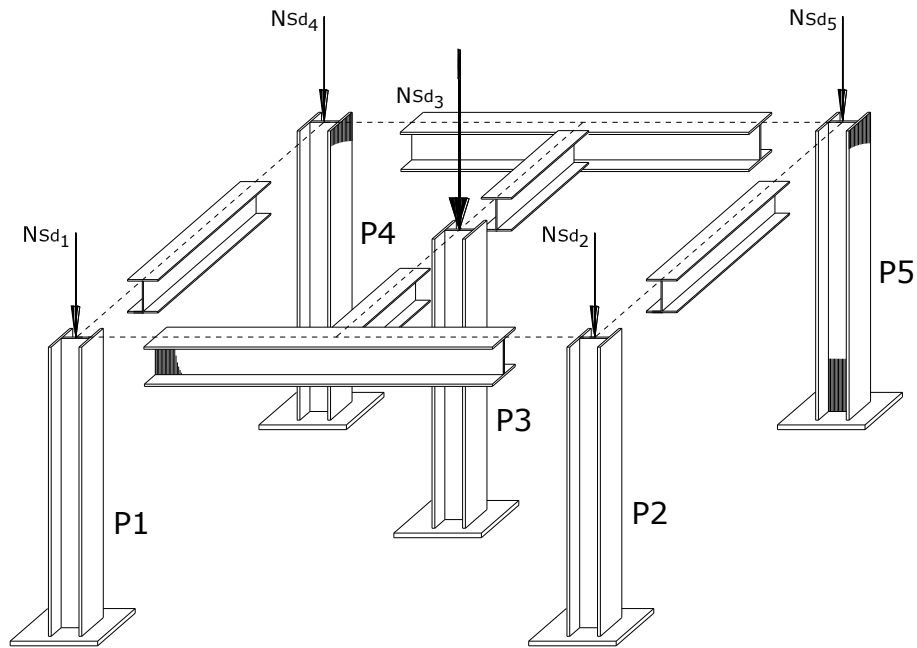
Pilar central estabilizado pelos pilares periféricos
